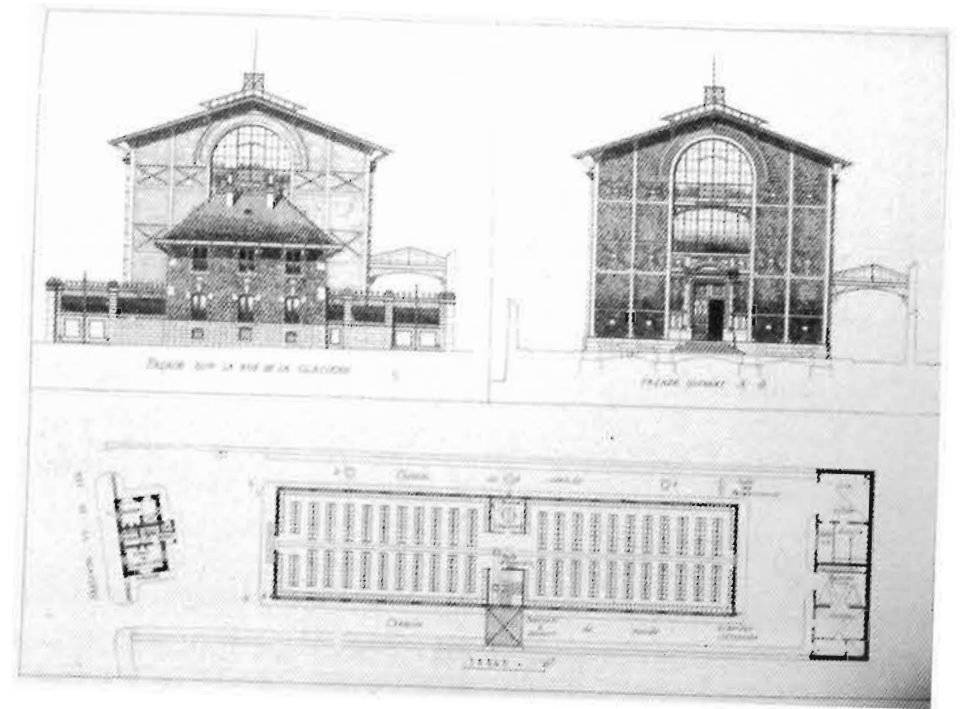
Façade du bâtiment des archives du Crédit Lyonnais sur la rue de la Glacière («La Construction moderne», 20 juin 1891, pl. 70).
